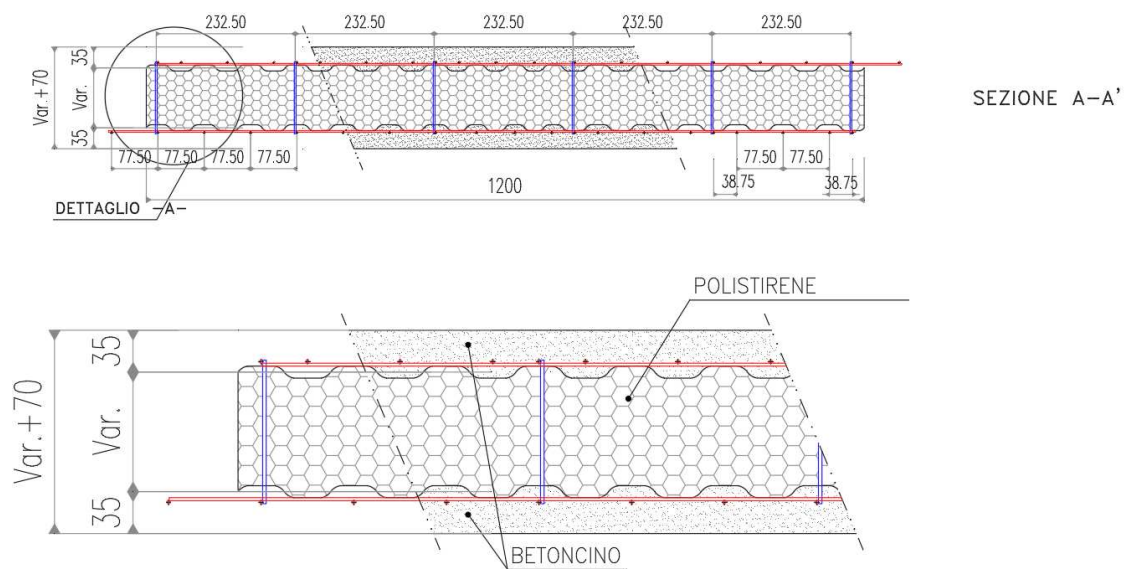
Rappresentazione della disposizione dell'armatura, dei connettori, e del profilo ondulato della lastra di polistirene
